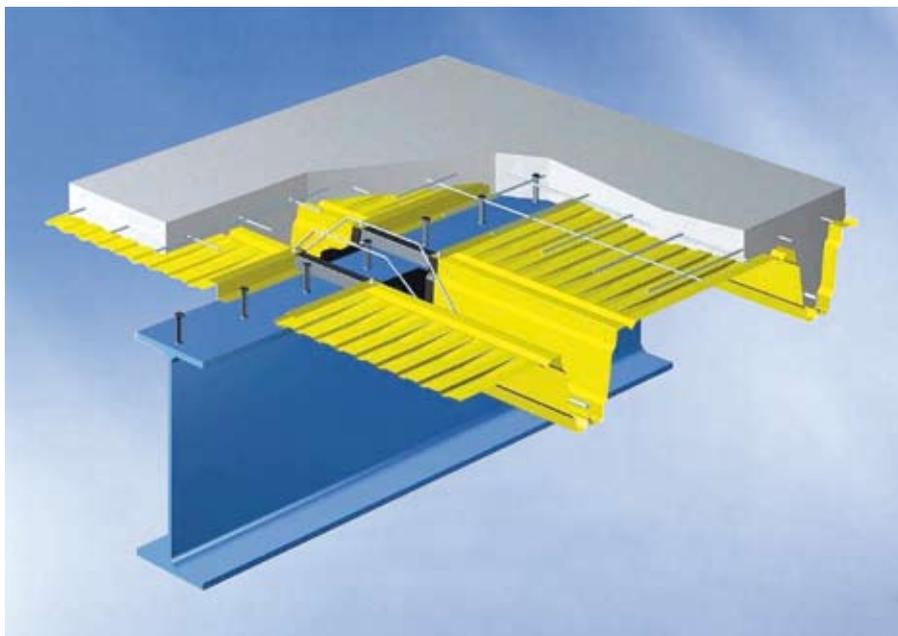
Illustration du système de plancher Hoesch Additif porté par des poutres en acier
